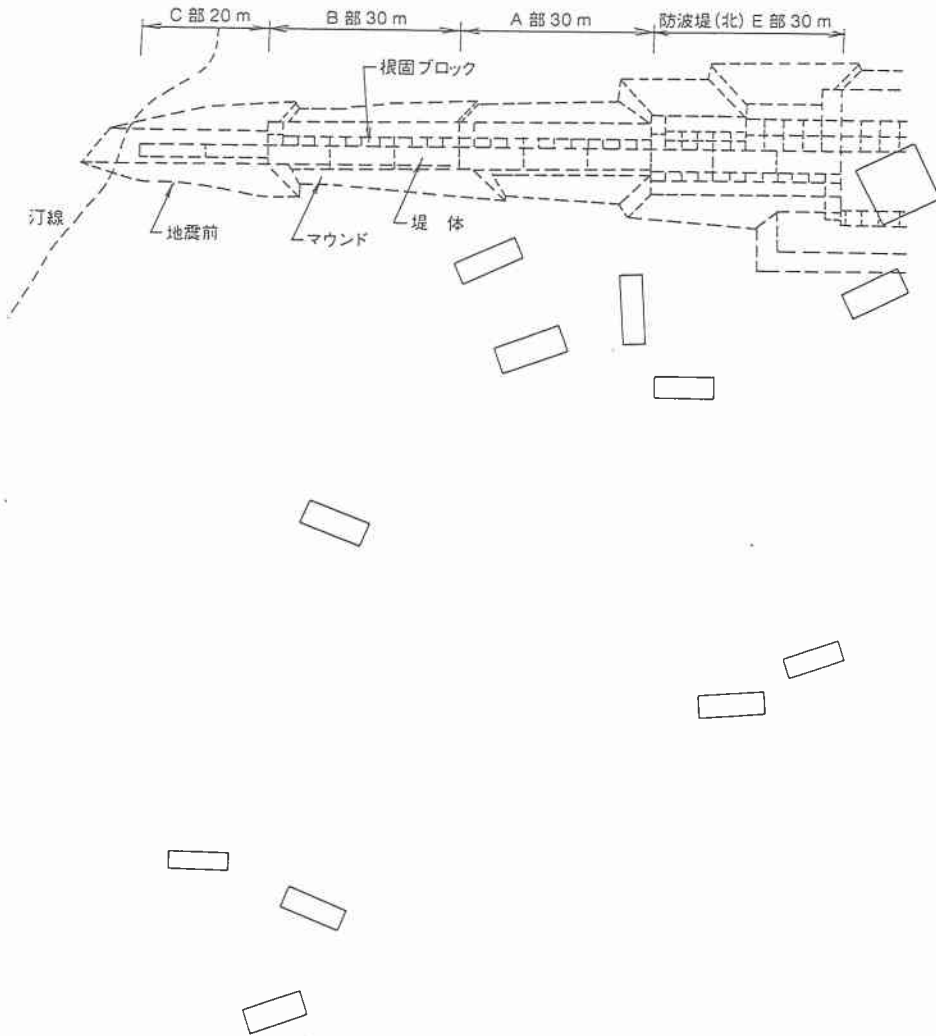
奥尻港護岸（防波）(北) 被災状況平面図
